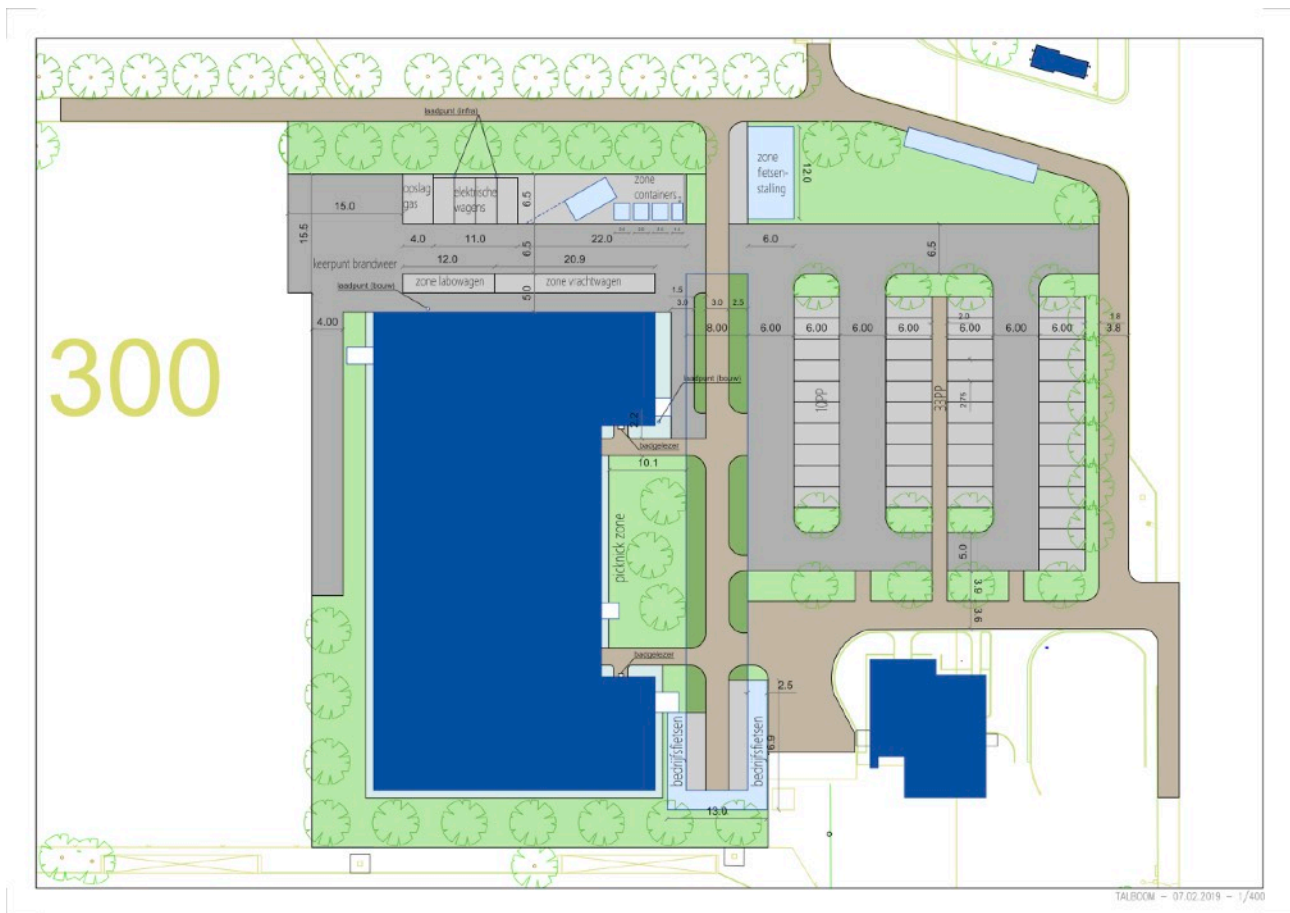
Plan van de geplande ingreep. © Talboom 7/2/2019
